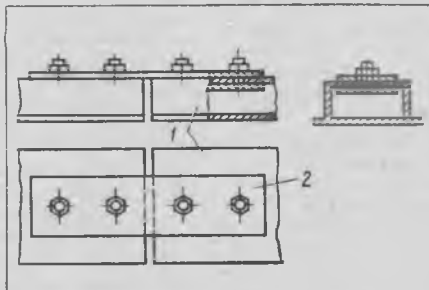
Конструкция шинпровода: 1 — продольная секция; 2 — накладка
